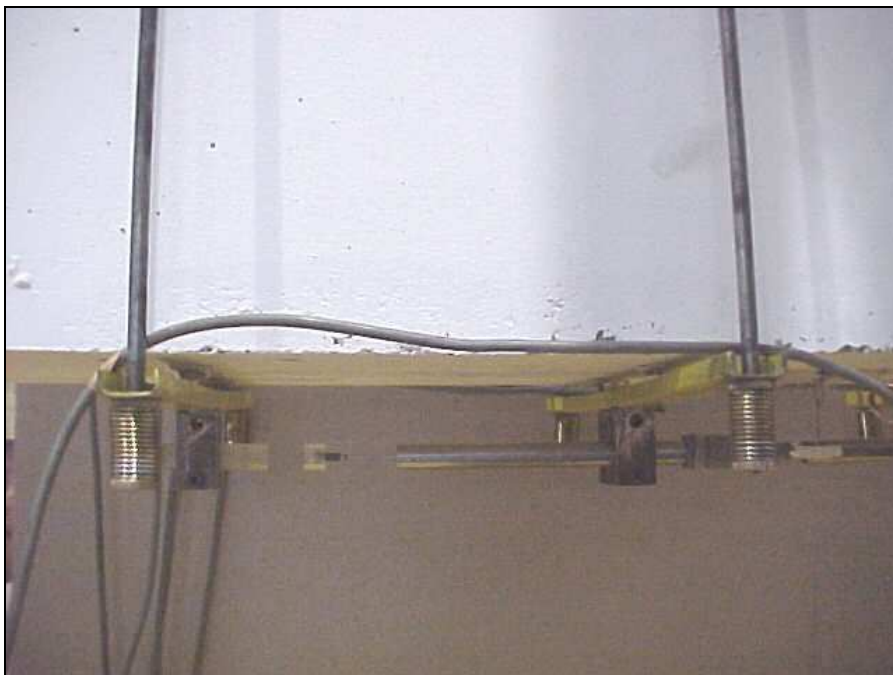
Vista lateral de um medidor colocado na zona inferior de uma das vigas a ensaiar.
